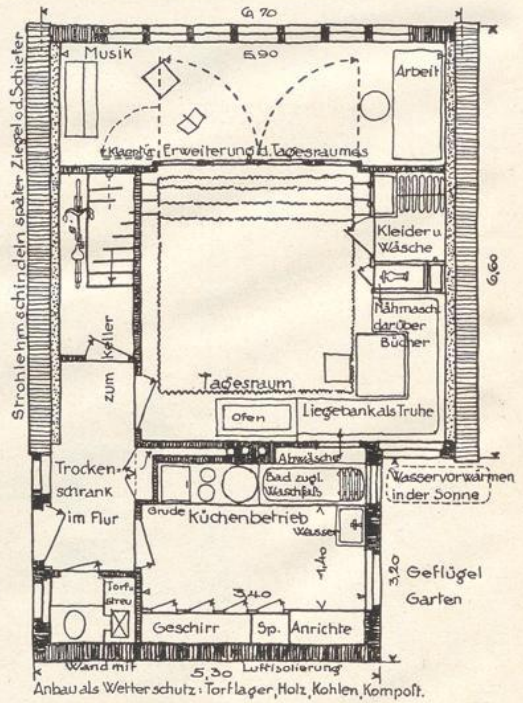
Grundriß des Erdgeschosses. (1:100)
